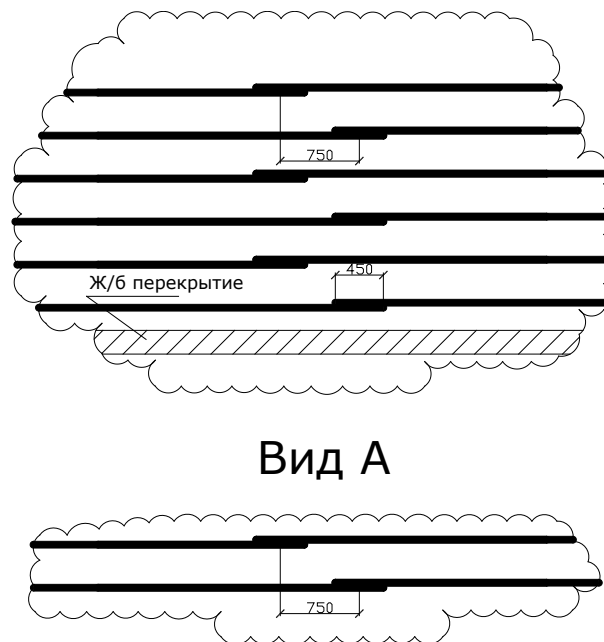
Схема напустка горизонтальної арматури стін
